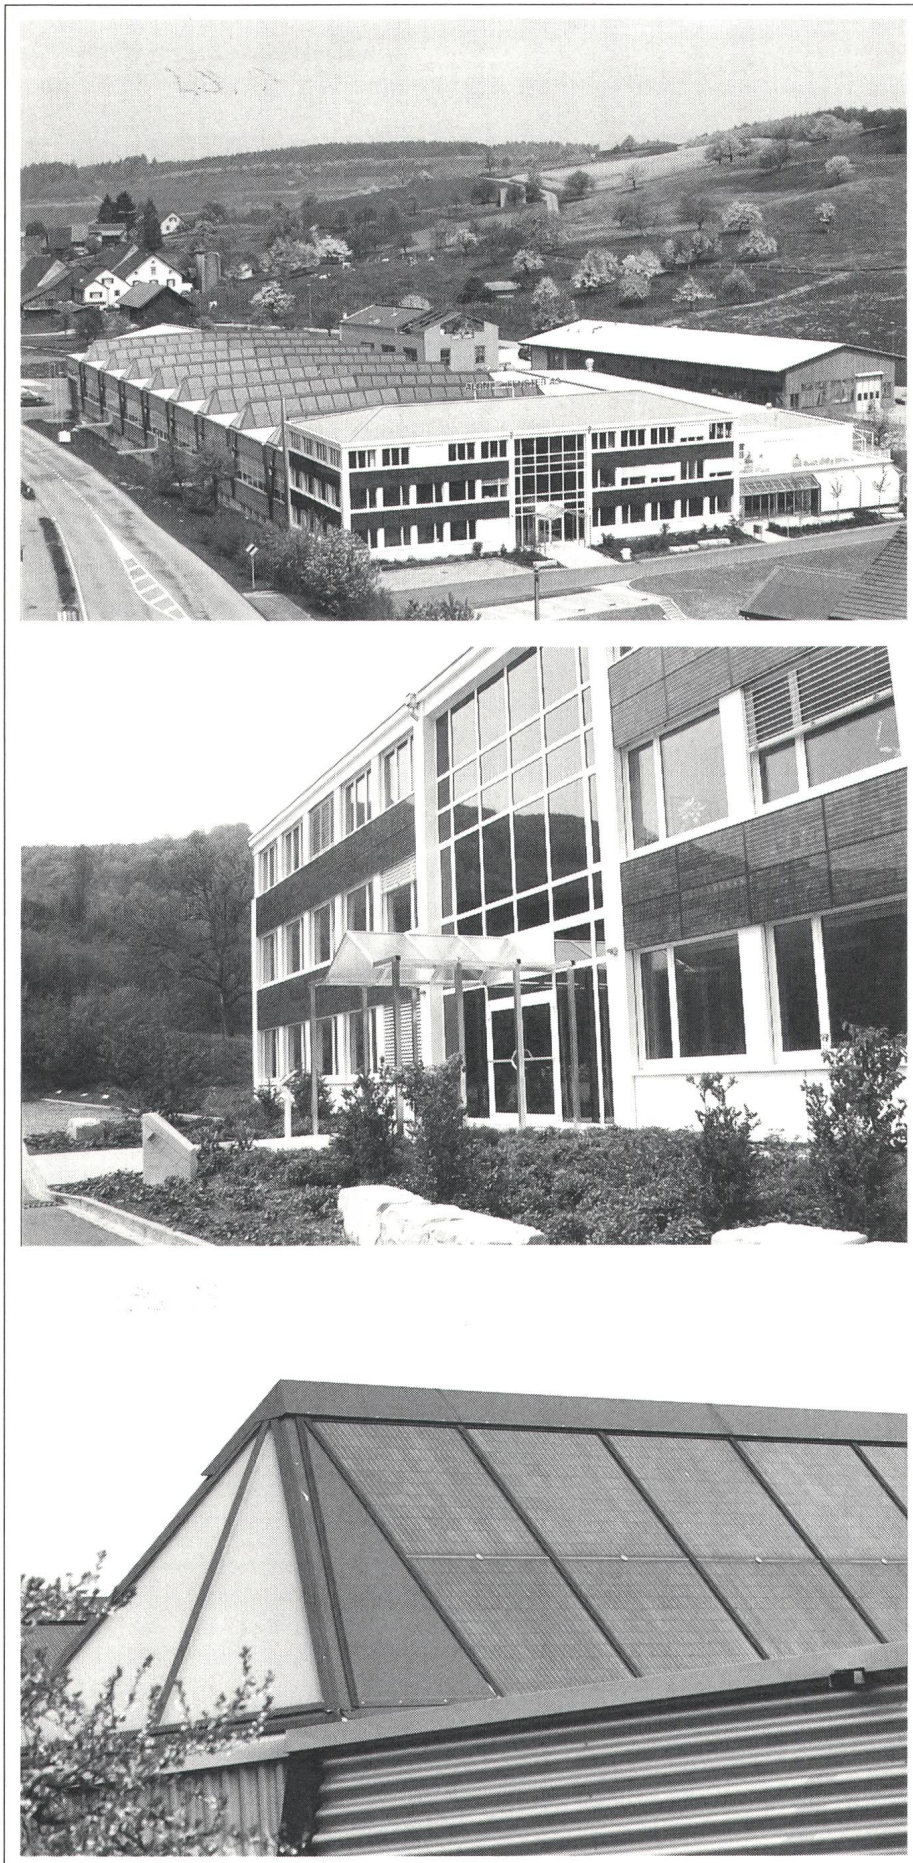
Fabrikneubau der Firma Aerni in Arisdorf (oben) mit fassadenintegrierten PV-Generatoren (Mitte) und Grossmodulen im Sceddach (unten)
